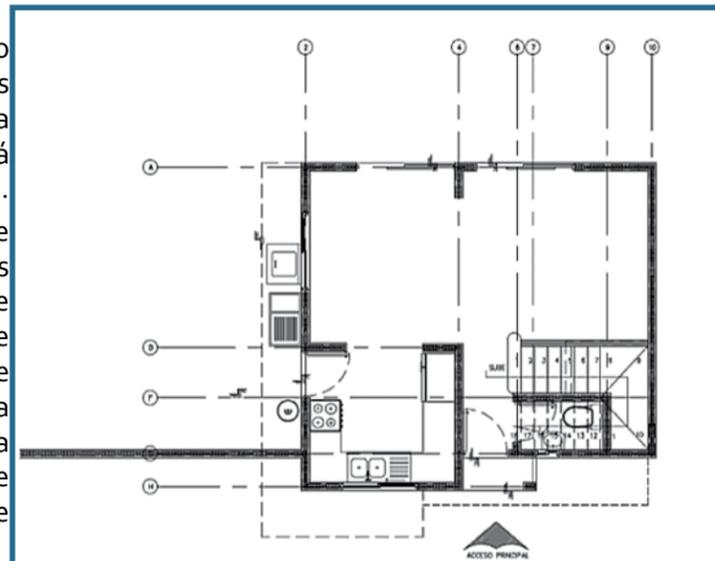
Planta arquitectónica vivienda 1er. nivel.
